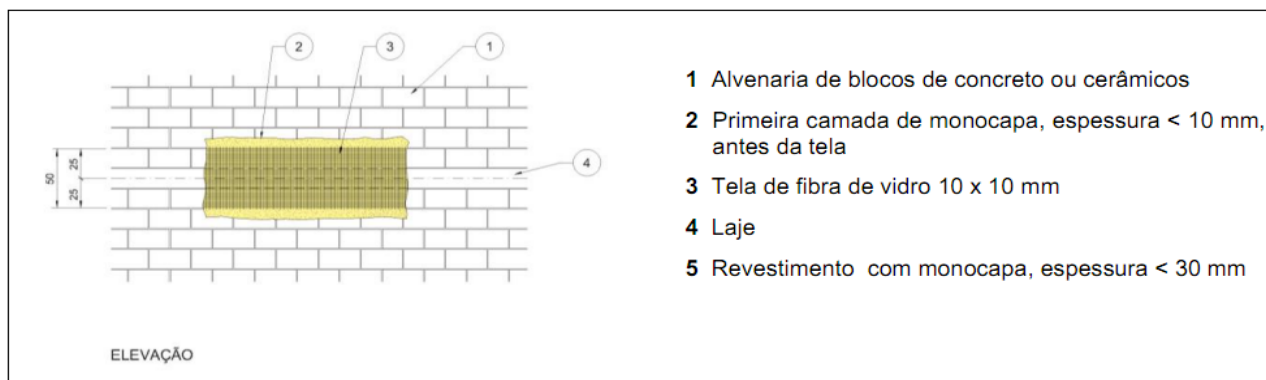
Reforço no entorno de laje em alvenaria estrutural
